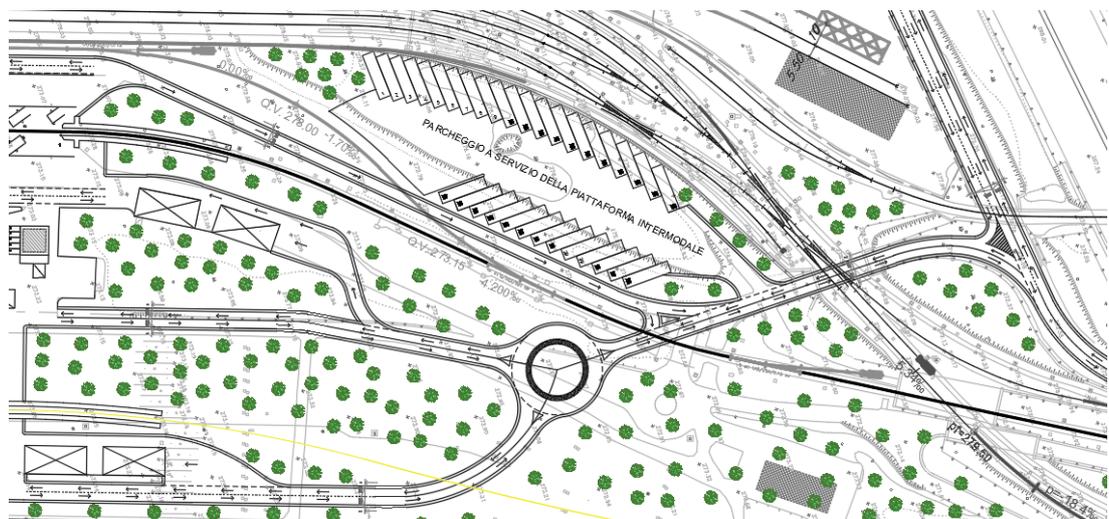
Estratto dello spazio carta di Autocad, comprendente tutte le infrastrutture stradali di accesso all'AFA ed il parcheggio a servizio della piattaforma intermodale
